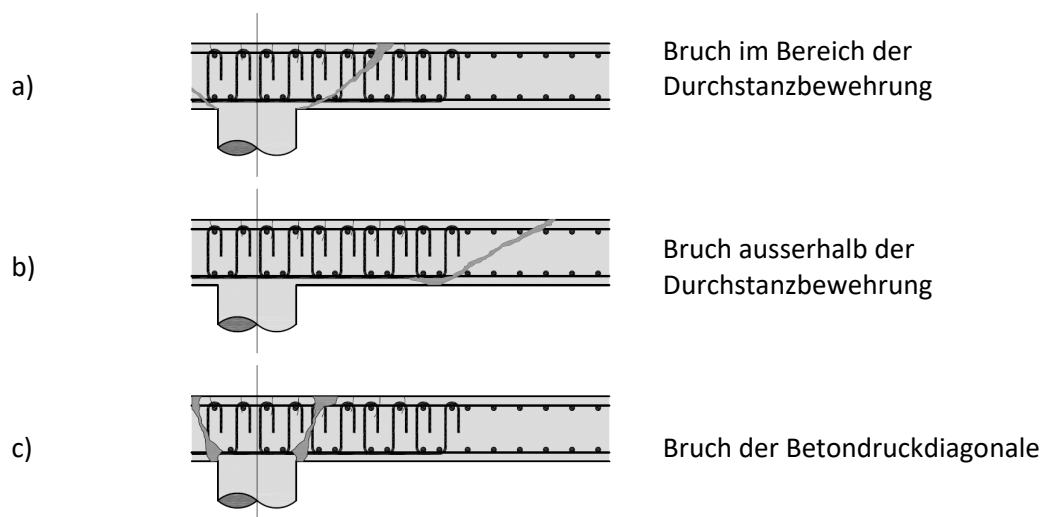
Versagensmechanismen für Platten mit Durchstanzbewehrung: a) Bruch innerhalb des durchstanzbewehrten Bereichs, b) Bruch ausserhalb des durchstanzbewehrten Bereichs und c) Bruch der Betondruckdiagonale an der Stützenkante
